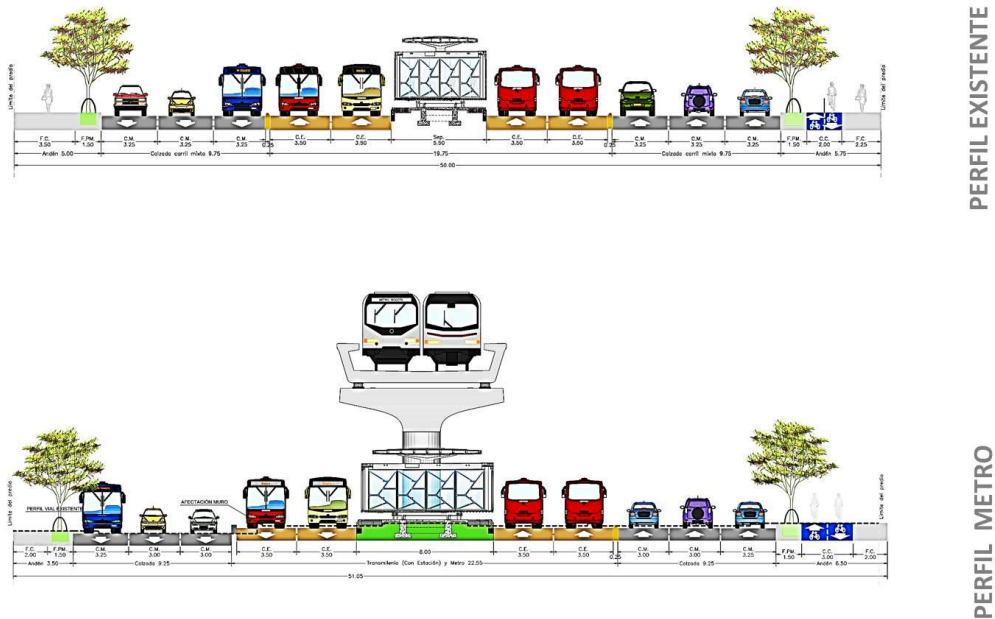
Sección transversal a nivel en estación BRT en la Avenida Norte Quito Sur (NQS) entre la Avenida 1ra de Mayo y la Avenida Octava Sur. Fuente: Elaboración Propia 2017. Imagen representativa, urbanismo puede variar según la zona (Anexo 3.3).
